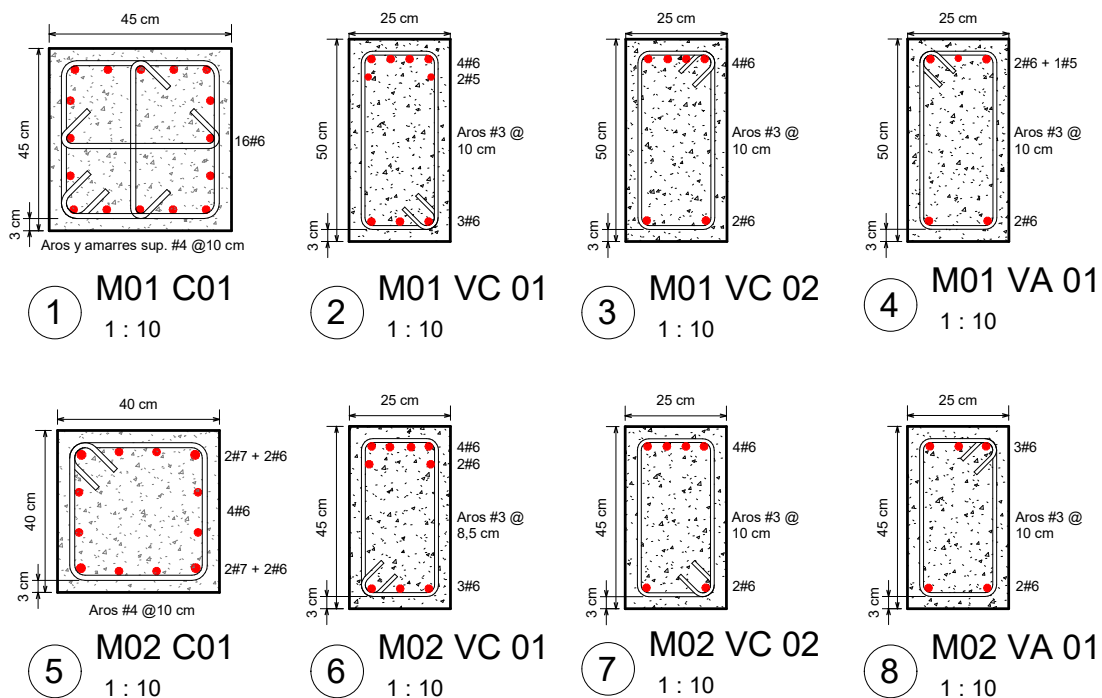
Detalle de las secciones transversales en columnas y vigas.
